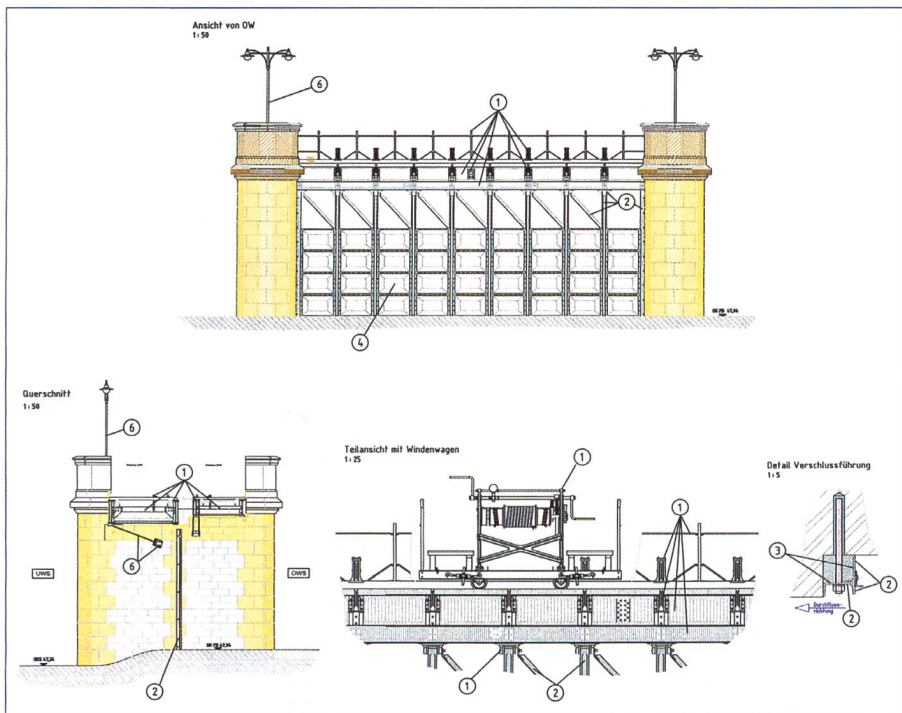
Beschichtungssysteme für Stahlwasserbauteile des Pretziener Wehrrs.
